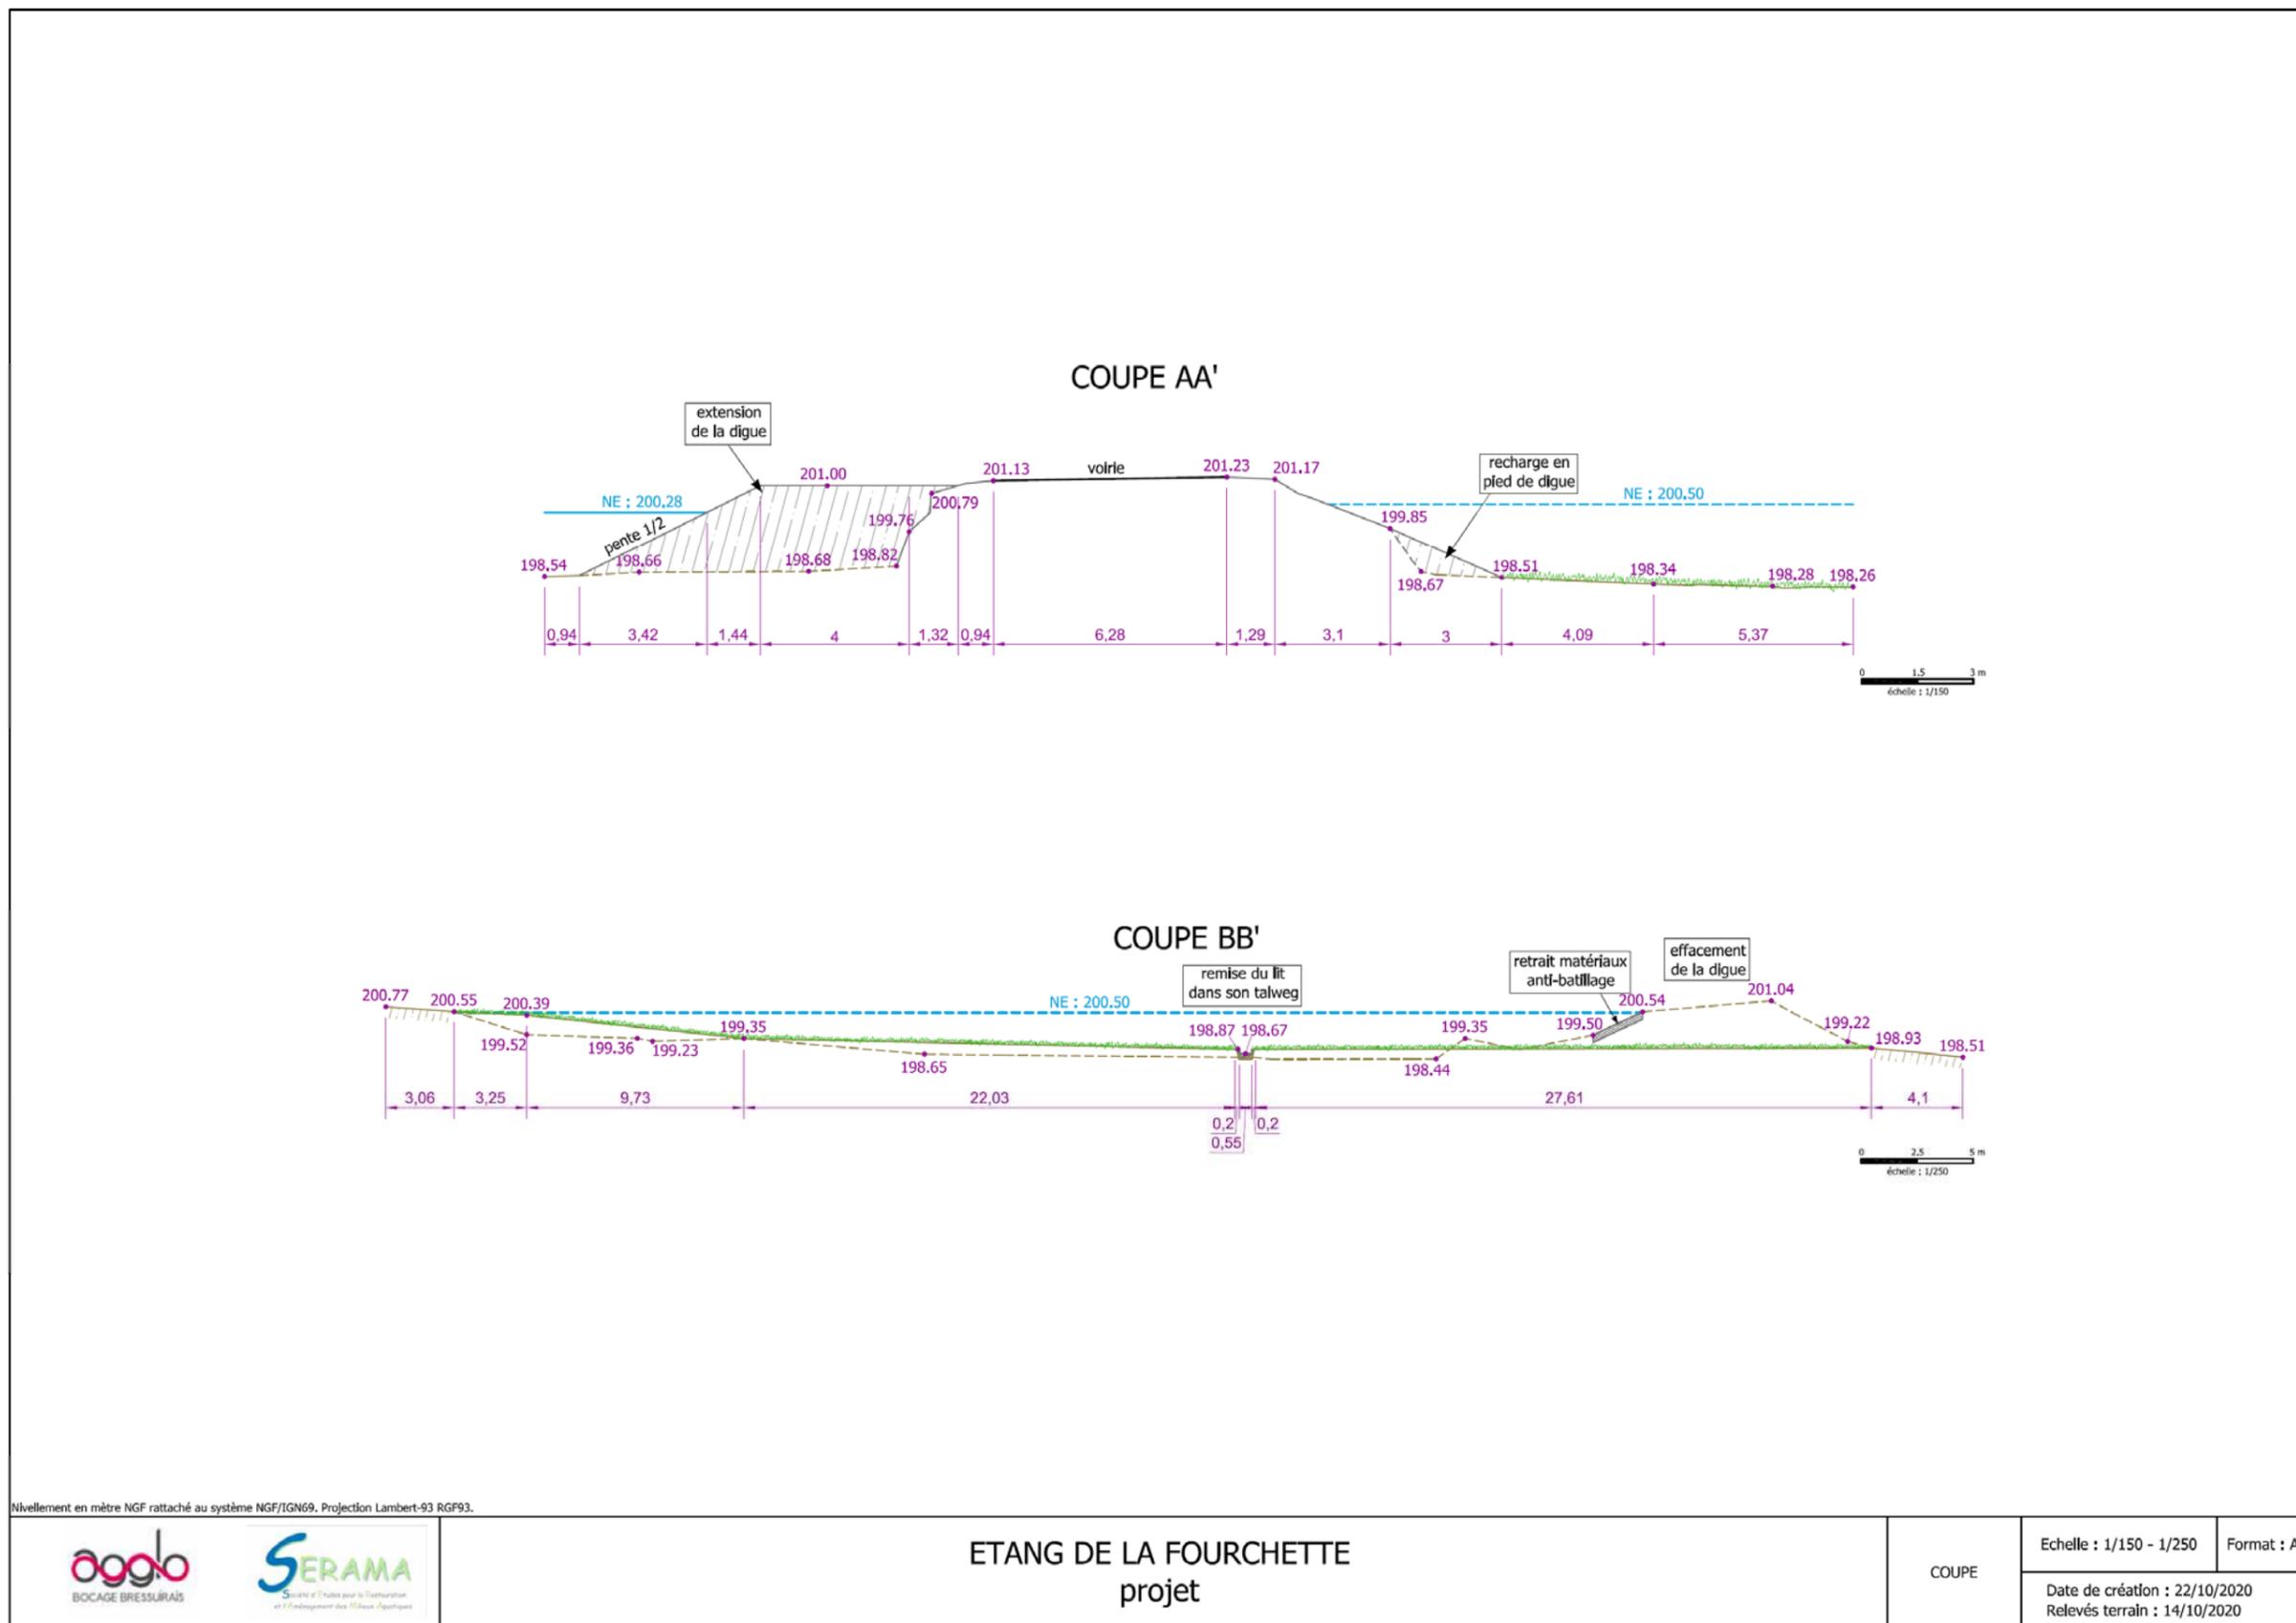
Profils en travers et coupe de projet sur le site du plan d'eau de la Fourchette
